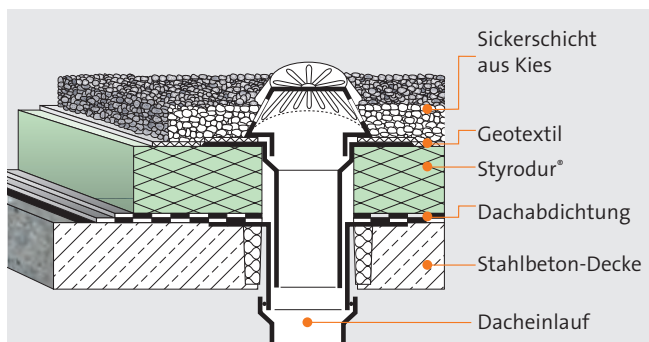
Dacheinlauf mit zwei Entwässerungsebenen für die Entwässerung der Dachfläche auf und unter der Dämmschicht.
